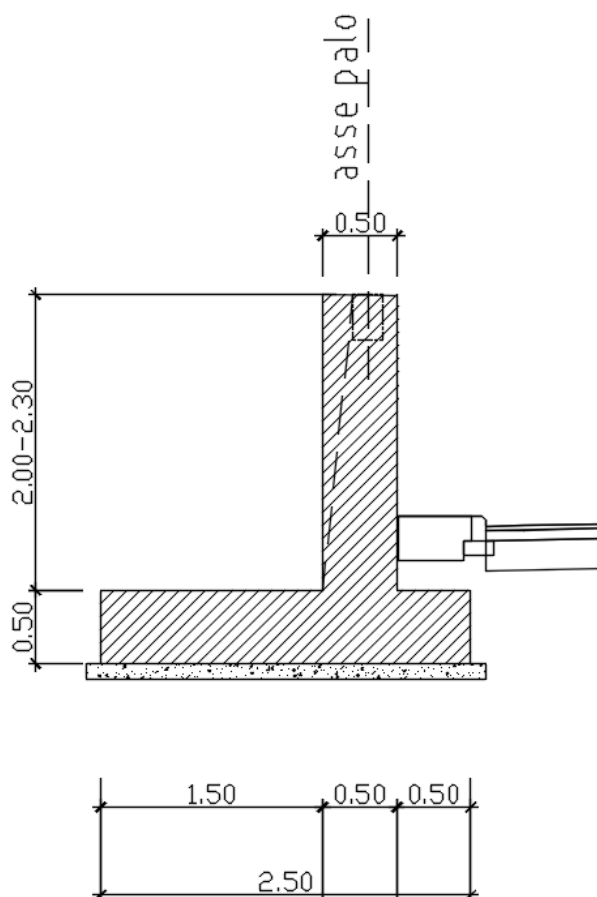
Sezione trasversale del muro di sostegno tipo 3 della deviazione IN06
